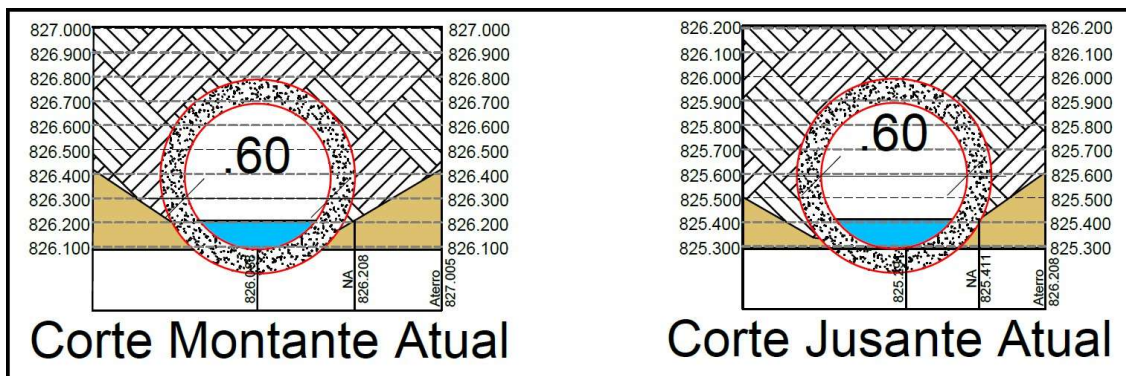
CORTES DAS SEÇÕES TRANSVERSAIS
